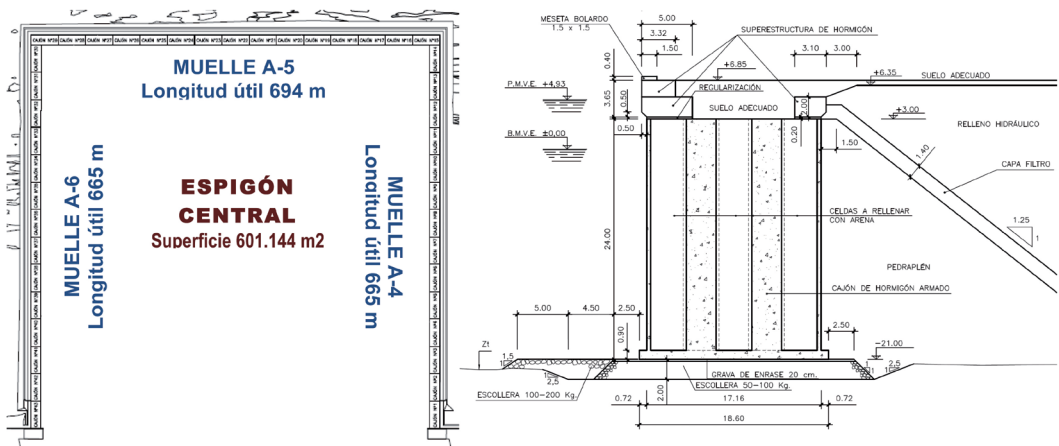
Planta General (izda) y Sección Tipo de proyecto (dcha).
